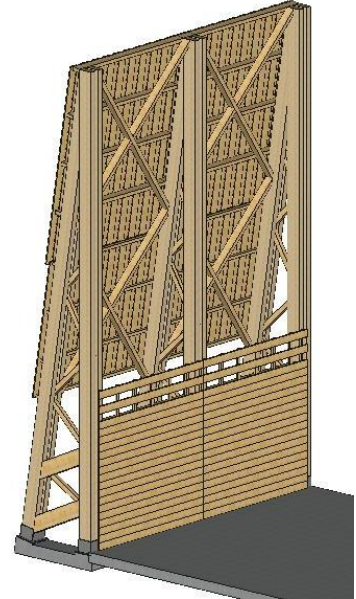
Structure de soutènement du sel par les poteaux treillis vue de l'intérieur
